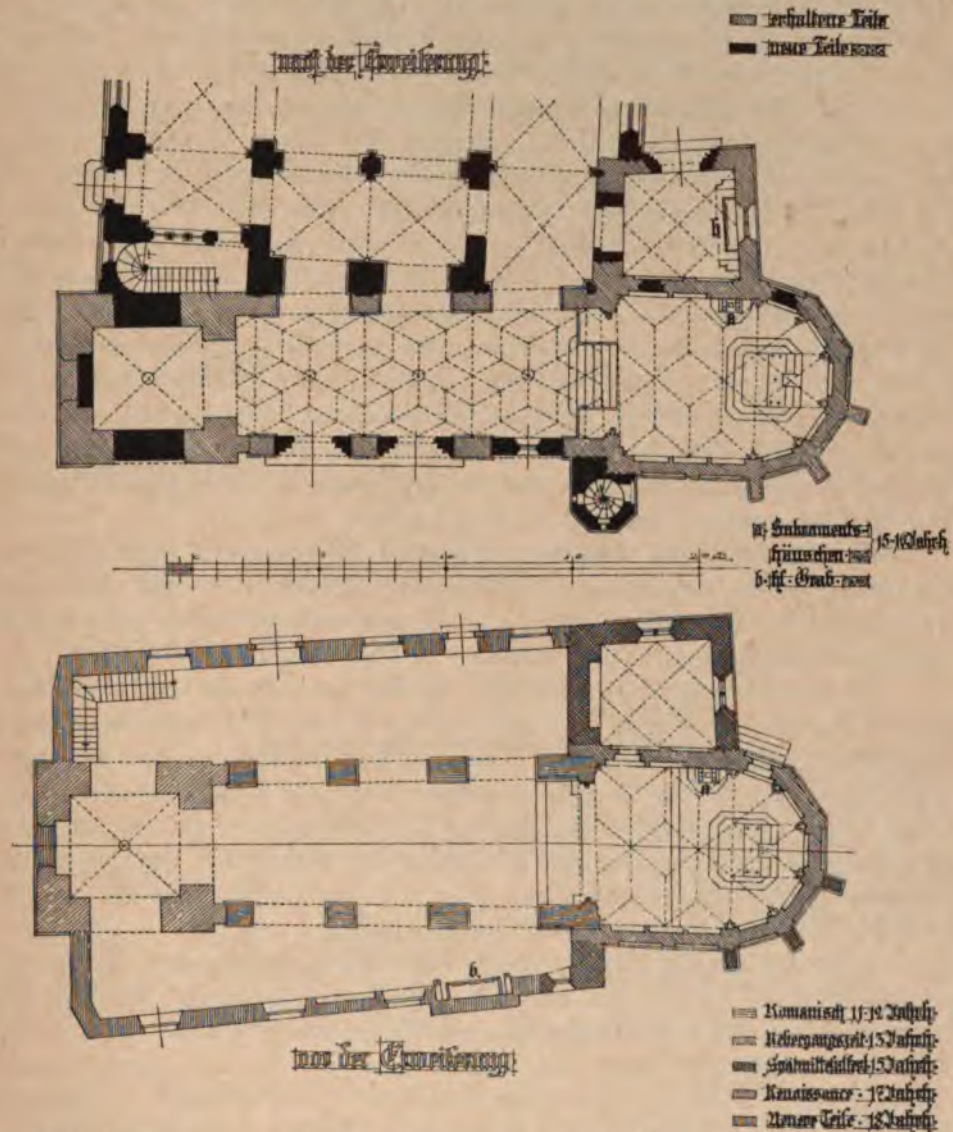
Remagen. Grundrisse der alten kath. Pfarrkirche vor und nach der Erweiterung.
